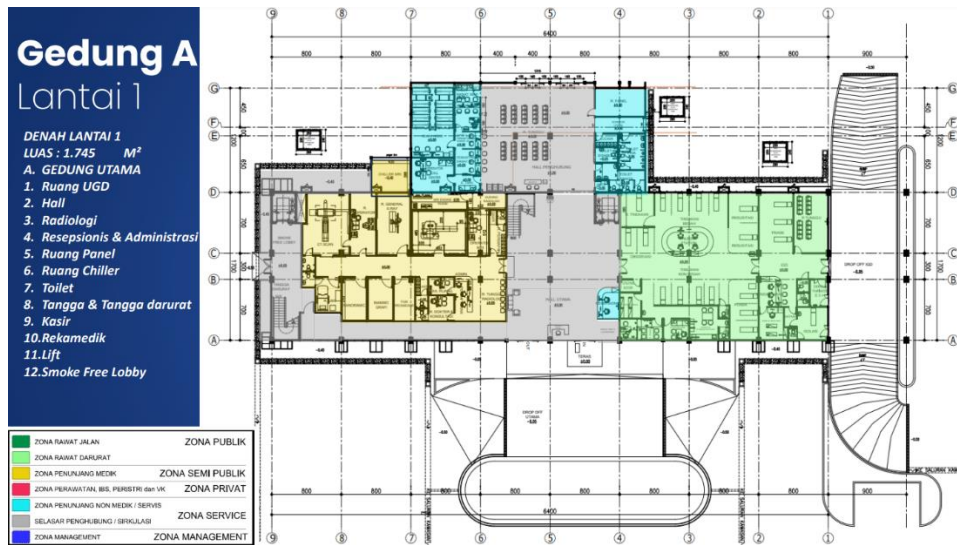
8 Site Plan RS Samsoe Hidajat
